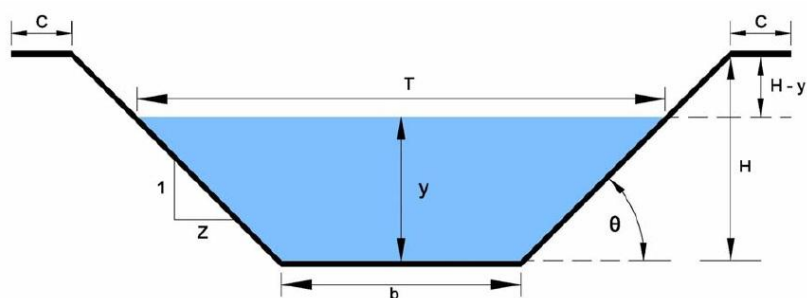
Esquema de la sección transversal de un canal trapezoidal de riego.
